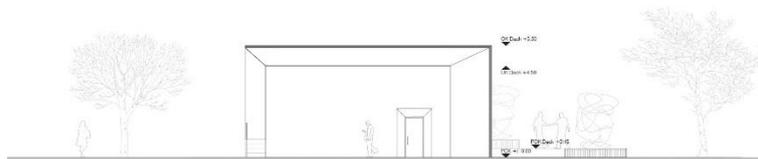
Präsentationsplakat 3, Grundriss, Schnitt
